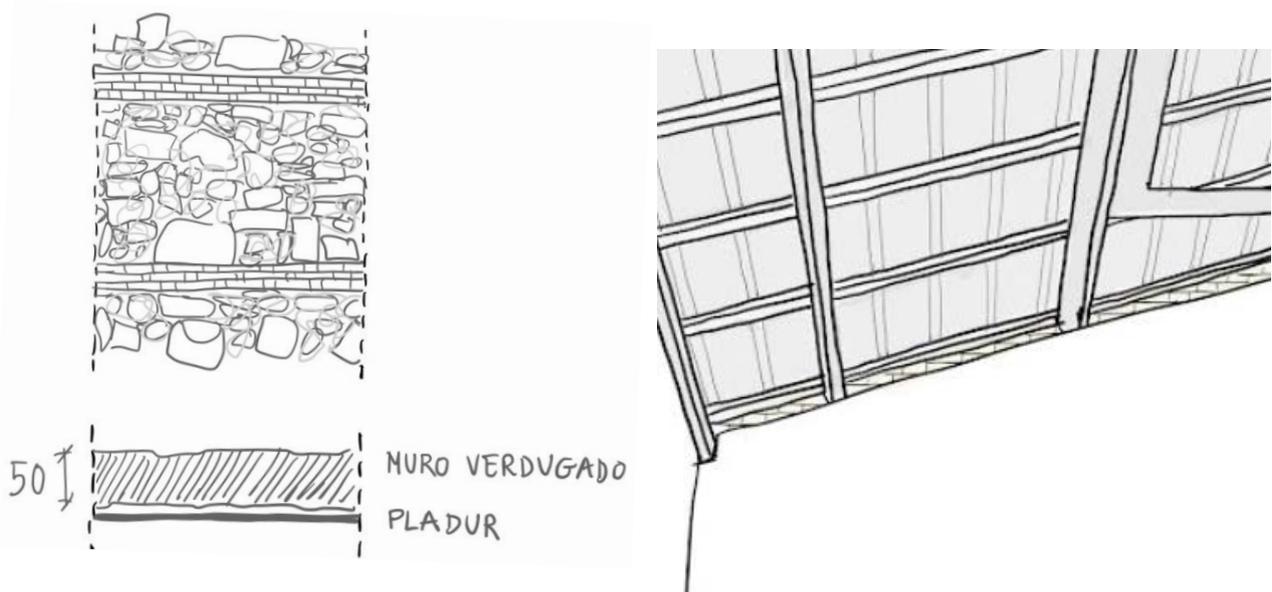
Muro verdugado de dos pies, en fachada exterior, en planta y desde una perspectiva interior. Fuente: elaboración propia.
